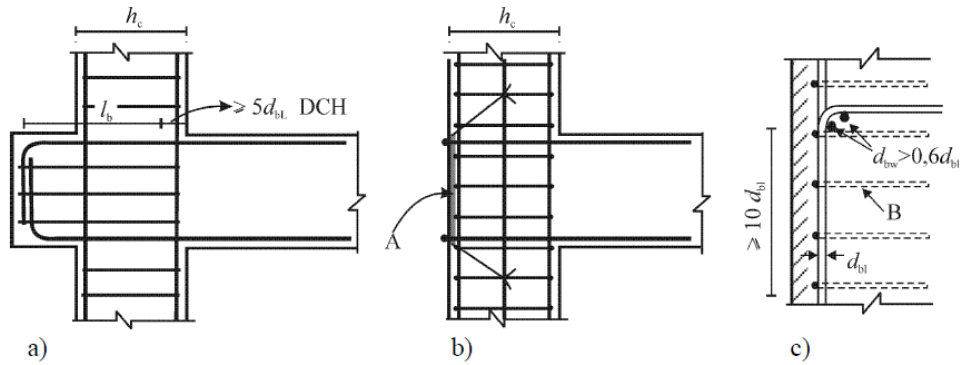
Disposições complementares para a amarração nos nós viga-pilar
